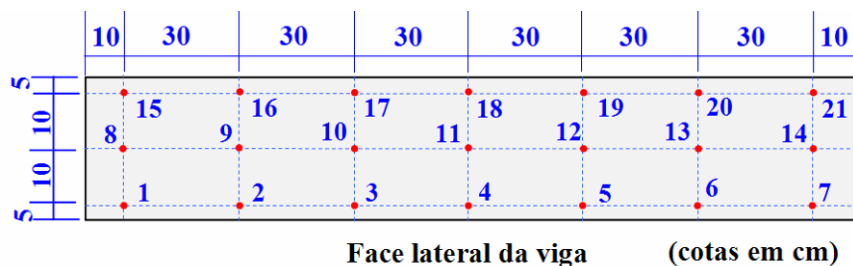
Pontos para o ensaio de ultra-som nas faces laterais das vigas
